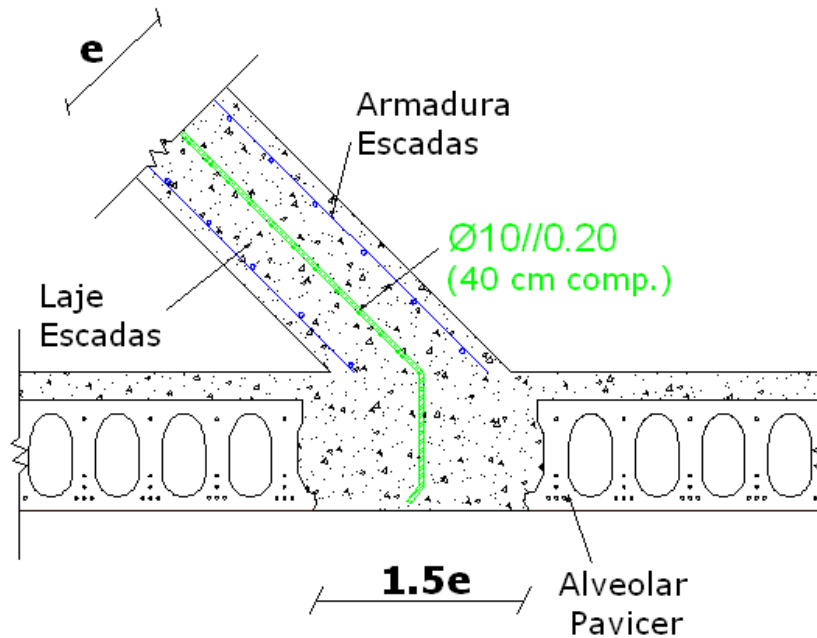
Pormenor tipo de apoio em laje de escadas - secção transversal.
